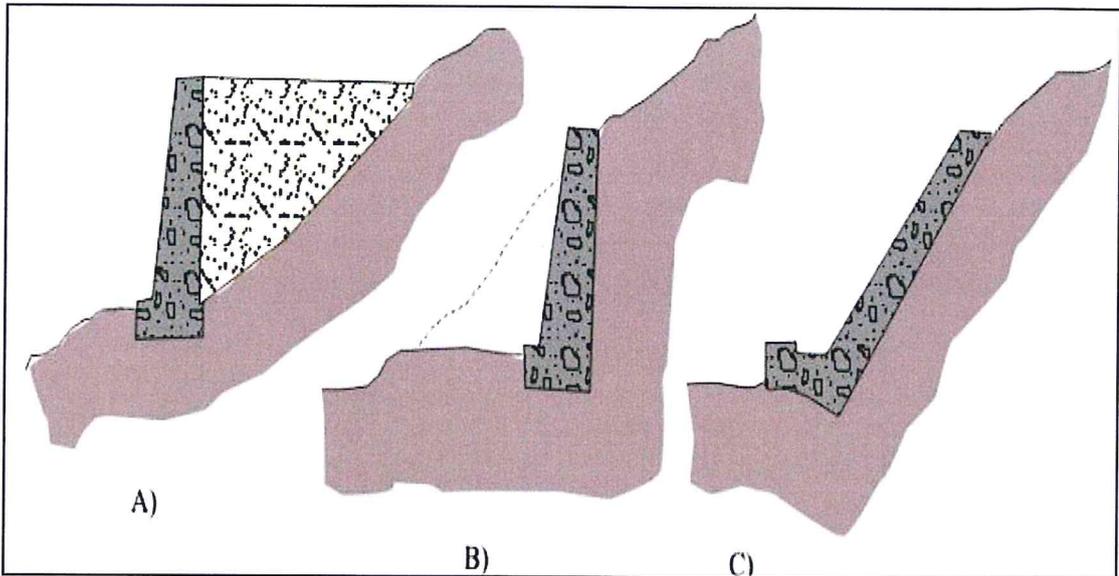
A) Muro de sostenimiento, B) Muro de contención, C) Muro de revestimiento (INGEMMET, 2000).
